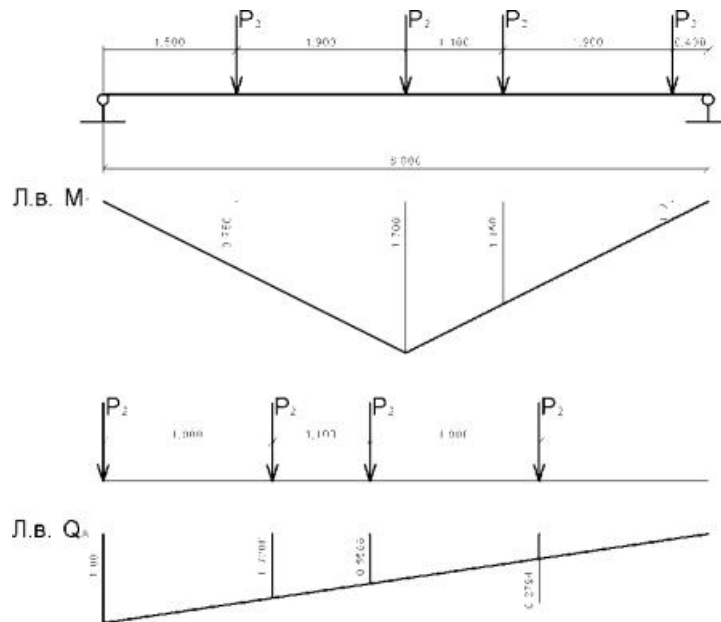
Завантаження ділянки поперечної балки між головними балками прогонової будови
